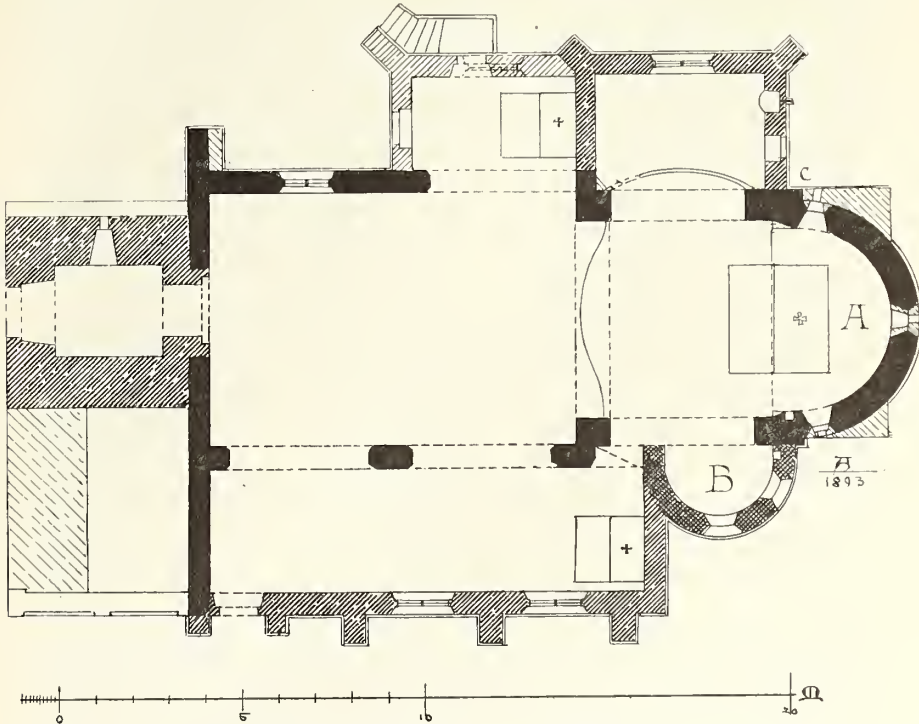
Morken. Grundriss der abgebrochenen katholischen Pfarrkirche.
